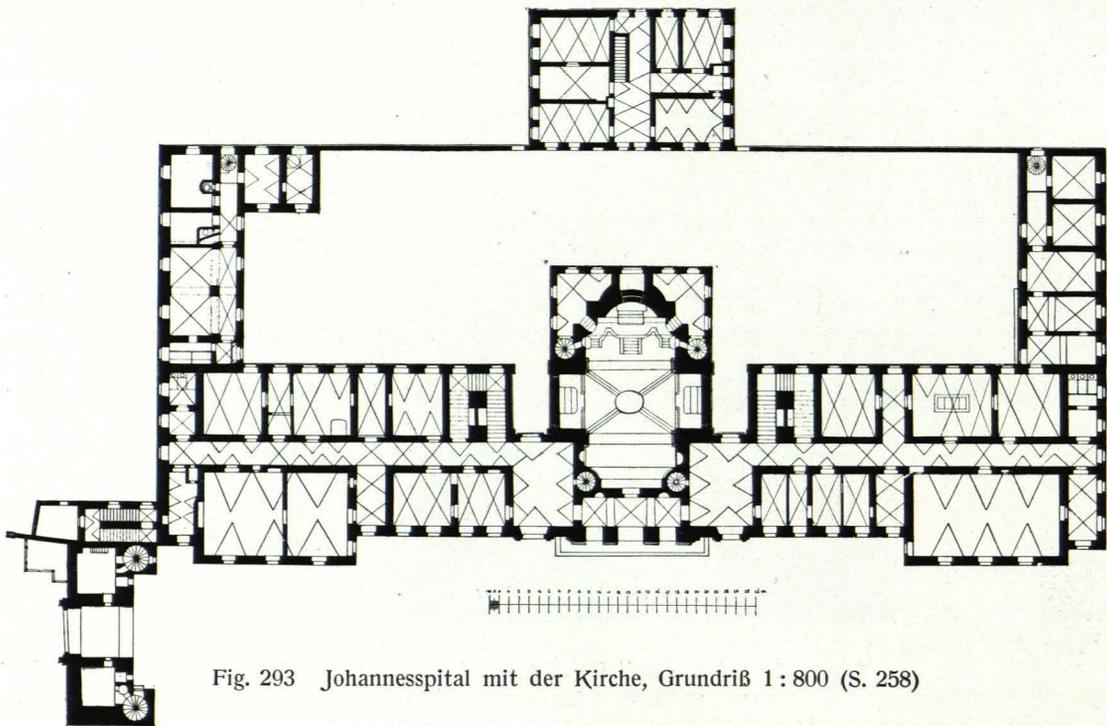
Johannesspital mit der Kirche, Grundriß 1:800 (S. 258)
